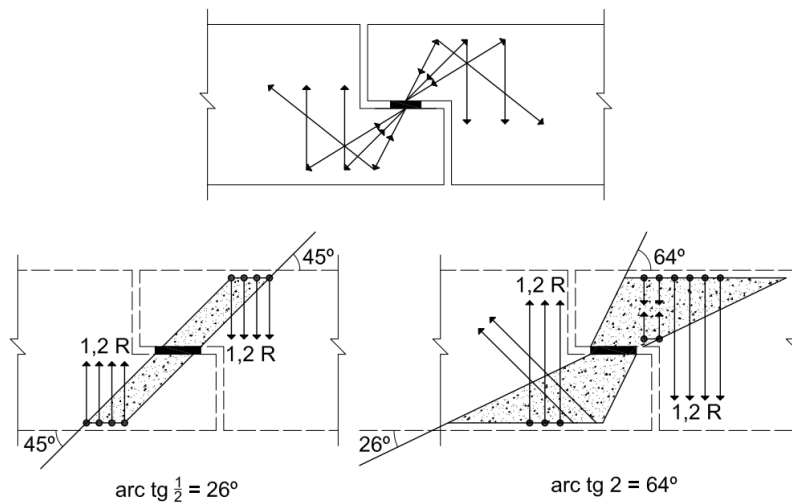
Arranjos de armaduras possíveis para os dentes de concreto.
